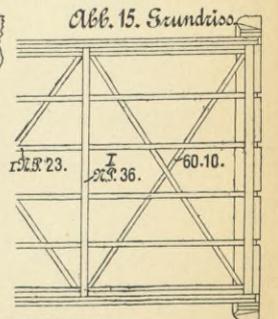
Grundriss. 23.36. 60.10.
